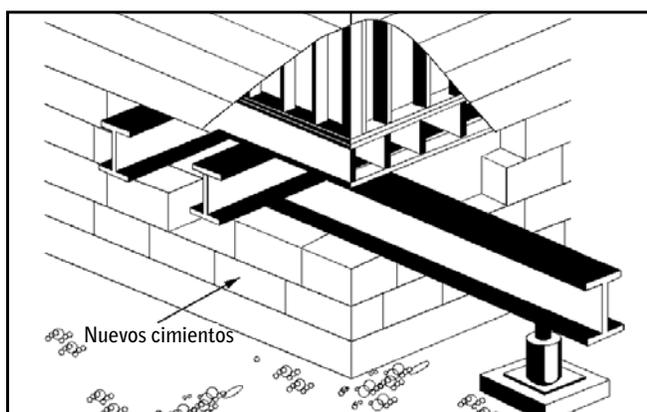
La casa se separa de los cimientos, se levanta con gatos, y se construyen nuevos cimientos por debajo.
